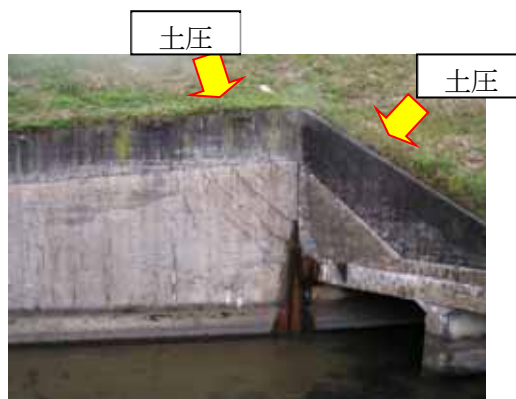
土圧によるせん断ひび割れ
